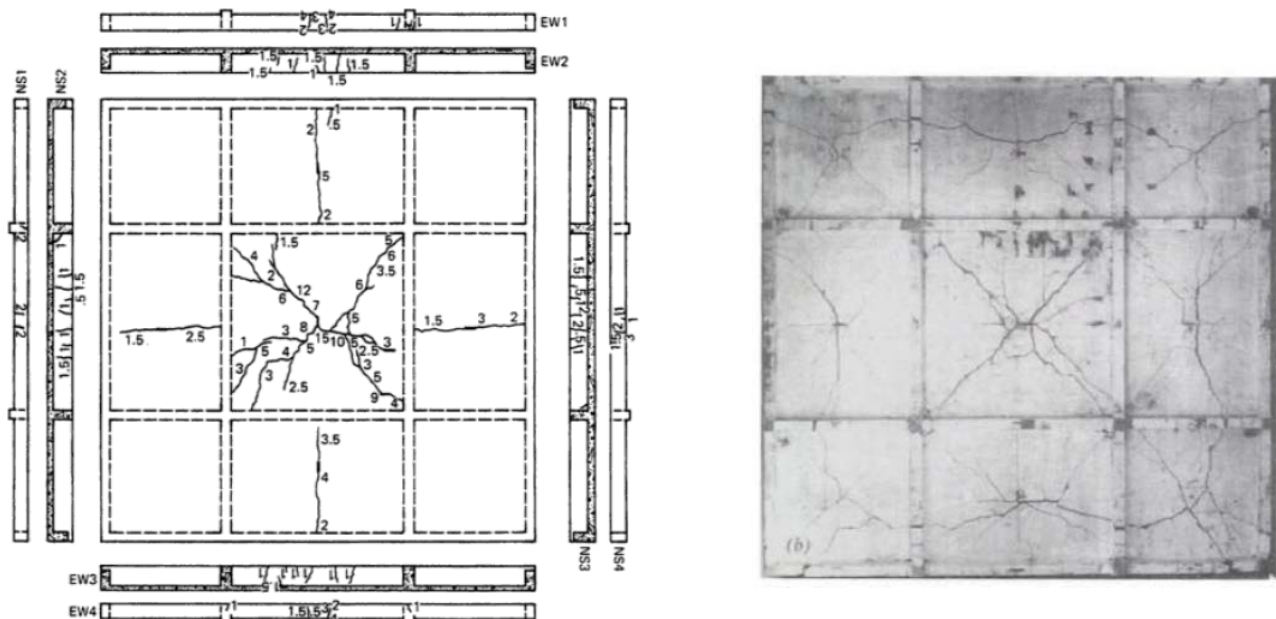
Izq.) Patrón de agrietamiento para piso de losa y viga a 21.5 KN/m², Der.) Superficie no cargada después de la prueba
